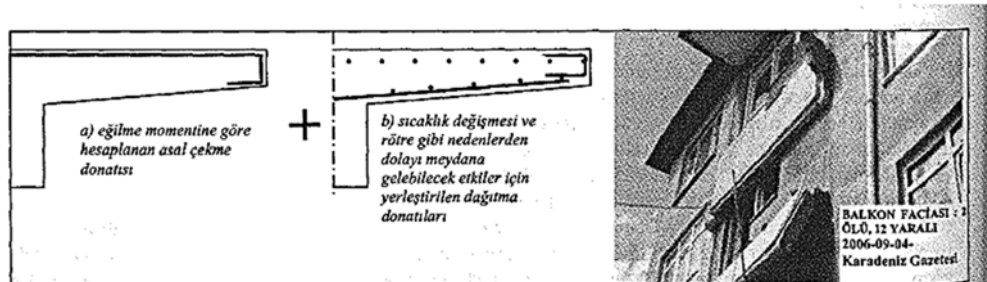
Bir doğrultuda çalışan döşemelerde nervürlü donatı için şematik donatı planı.
